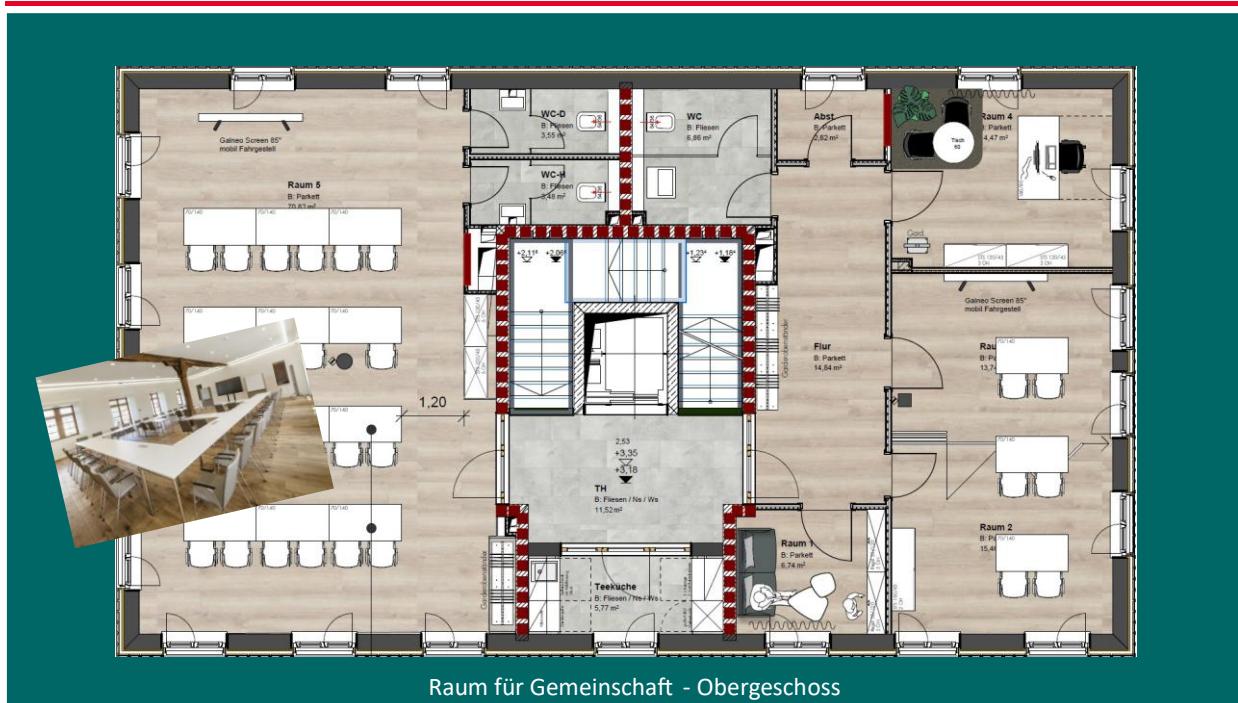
Grundriss Obergeschoss des neuen Bürgerhauses in Burgoberbach
